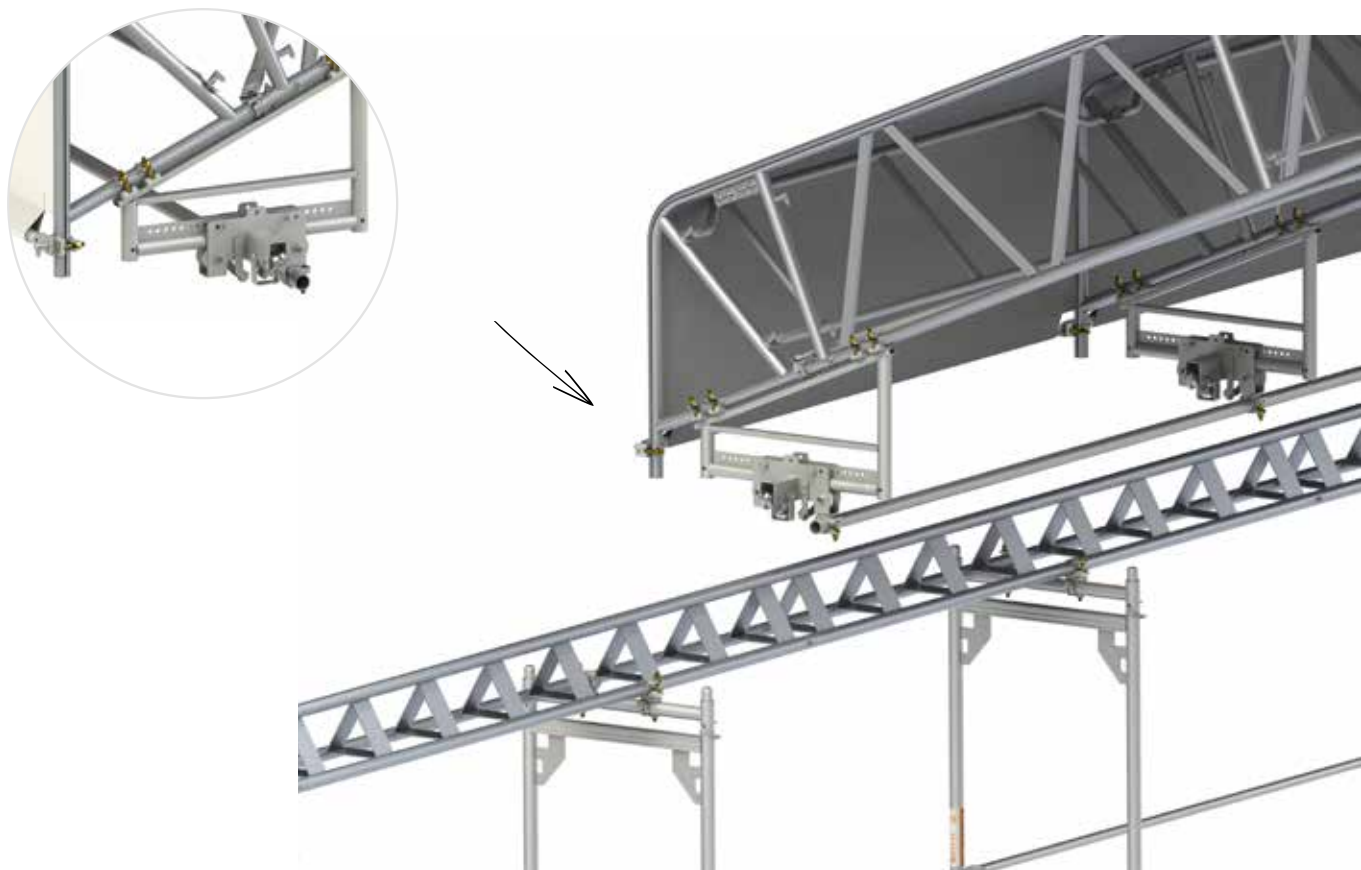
Przejezdna konstrukcja dachu systemu DELTA DACH.
